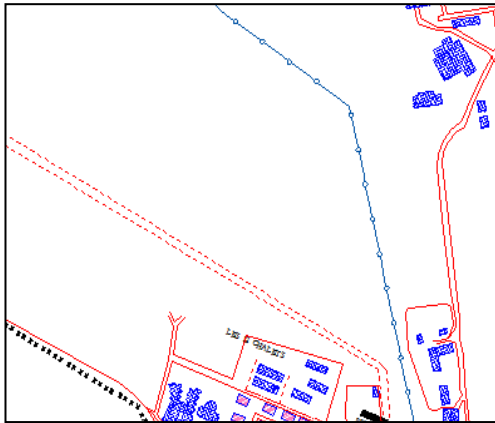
Vue en plan de la placette centrale avant l'intervention
